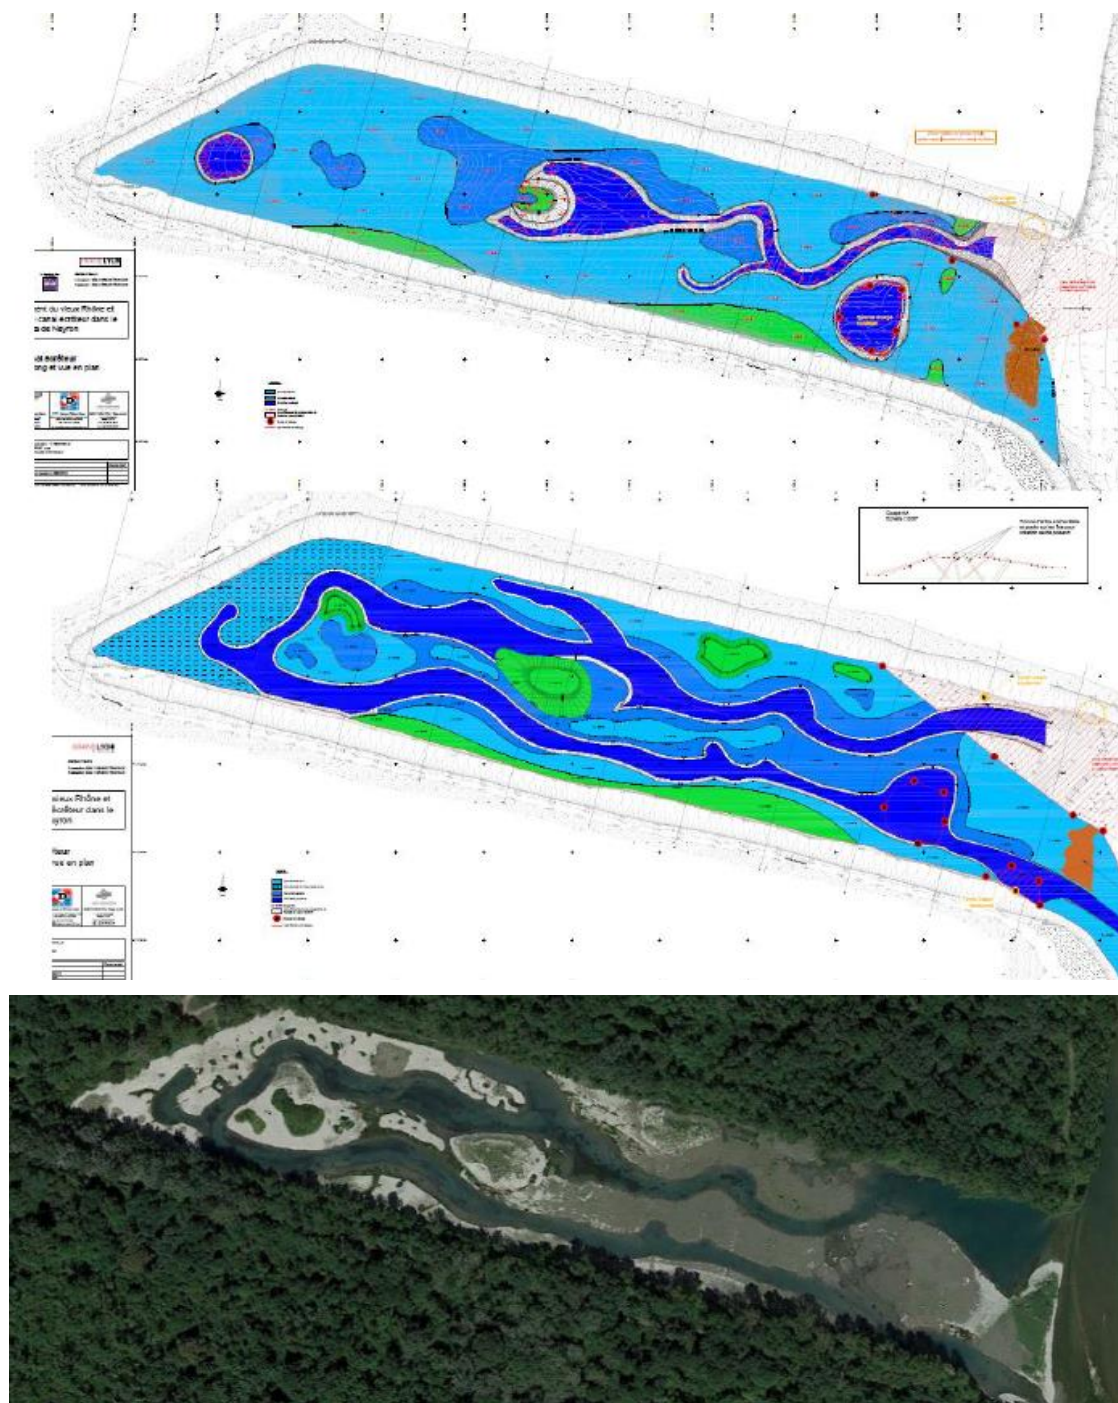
Canal écreteur – Photo aériennes (2015) et plan AVP du projet de restauration du canal écreteur (2013)
